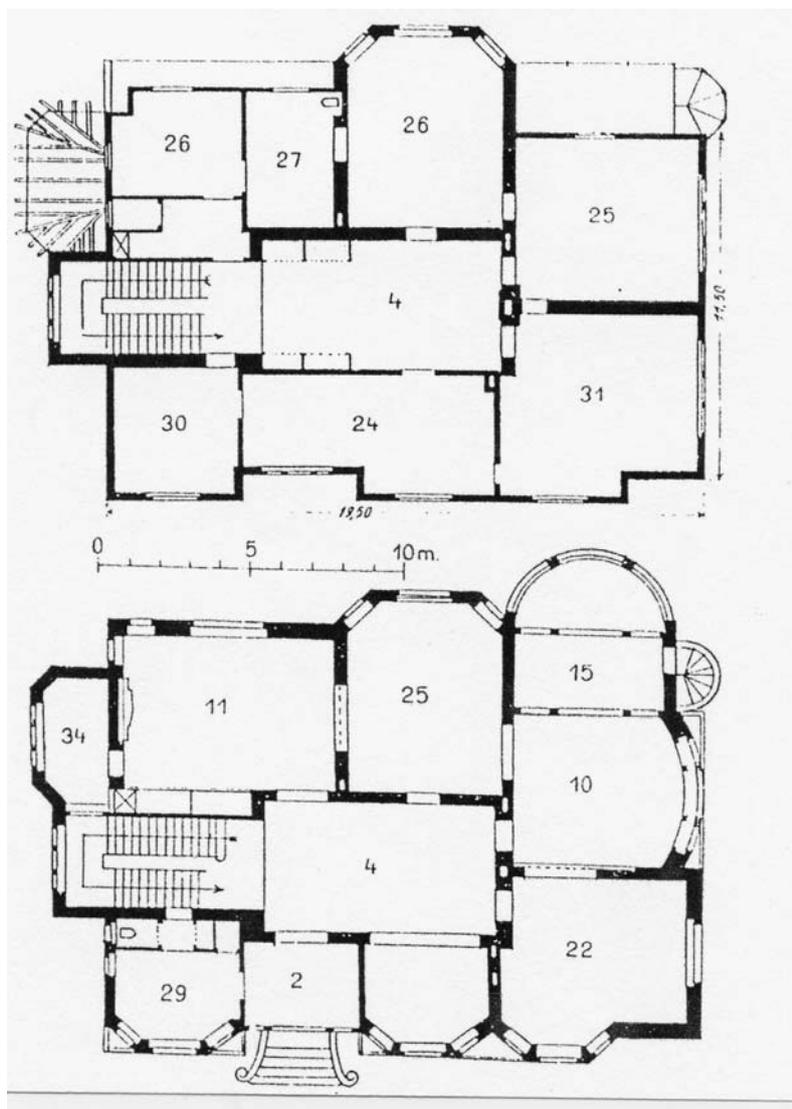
Haus Boeddinghaus, Grundrisse Erdgeschoss und Obergeschoss
